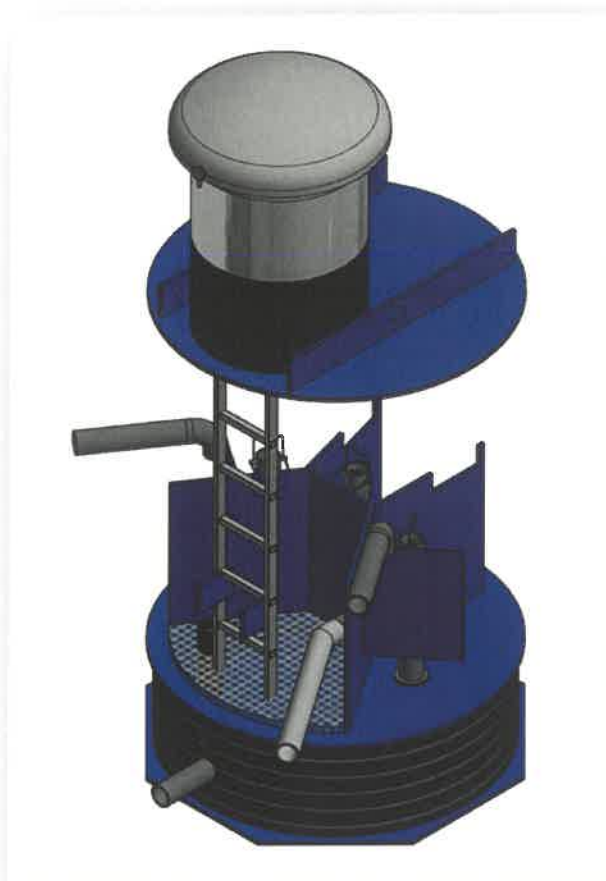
Spaccato 3D della camera sorgenti prevista a progetto
